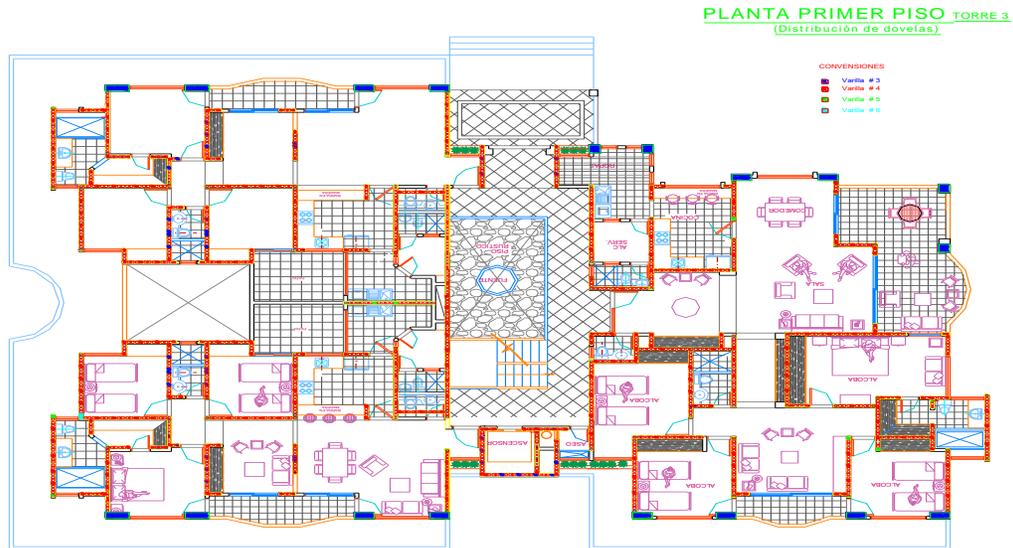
Plano arquitectónico Terrazas del Campestre
